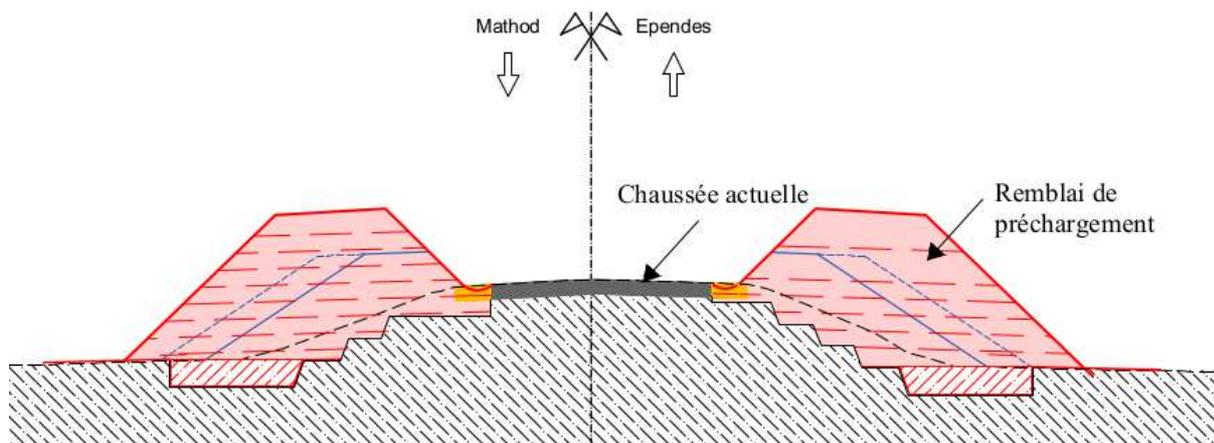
Coupe sur rampe d'accès du pont sur la Thielle avec remblais de préchargement (route ouverte)
